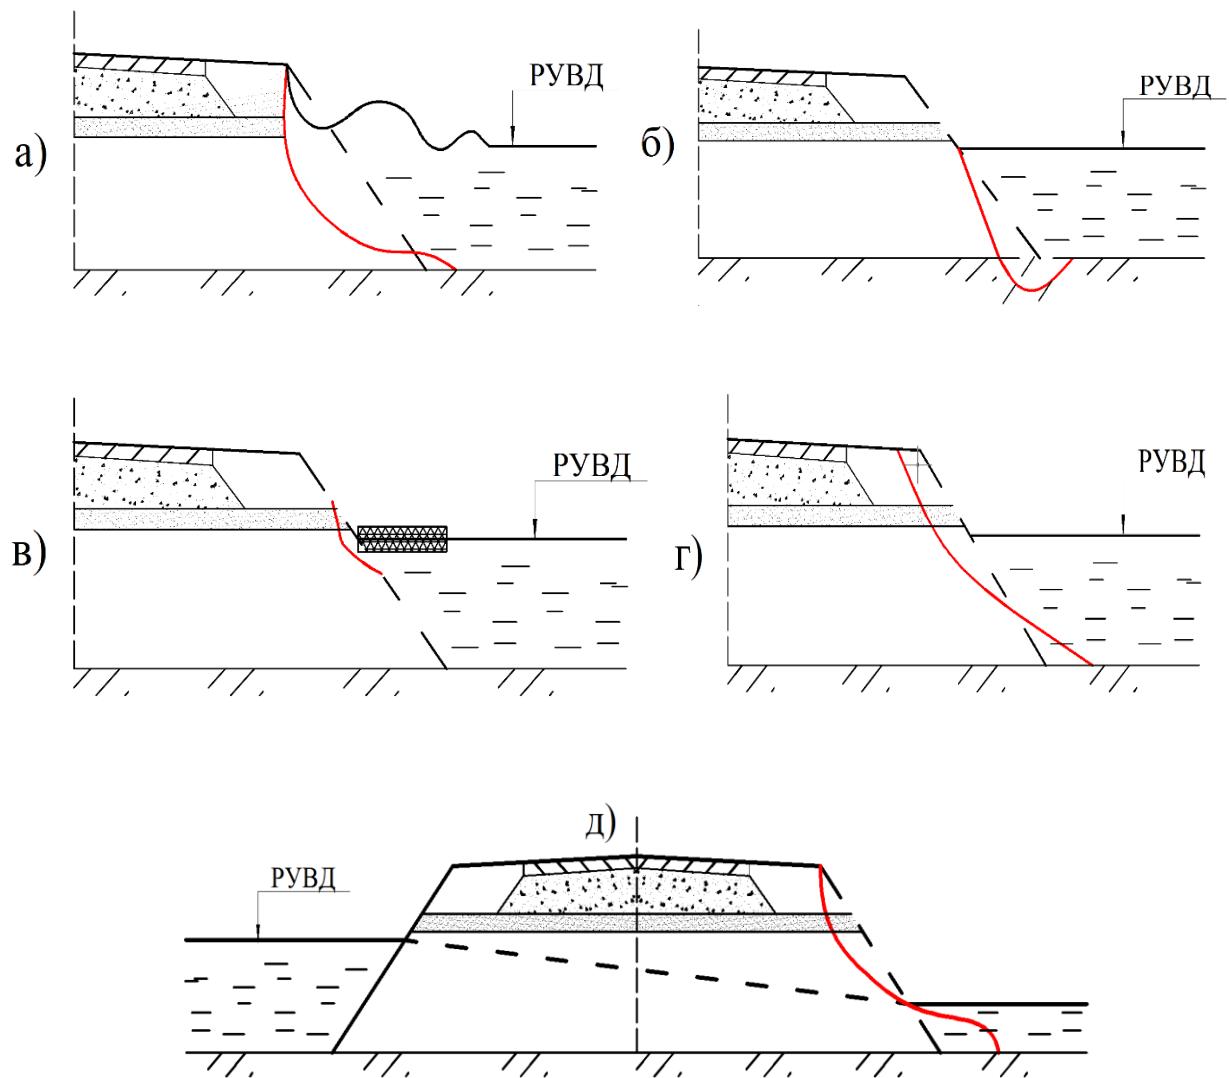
Наиболее типичные виды деформаций и разрушений откосов дорожных насыпей на пойменных участках: а - потеря устойчивости откосов, сплывы от набега ветровых и судовых волн; б - размывы подошвы откосов насыпей от движения водных потоков вдоль насыпи; в - деформации откосов
